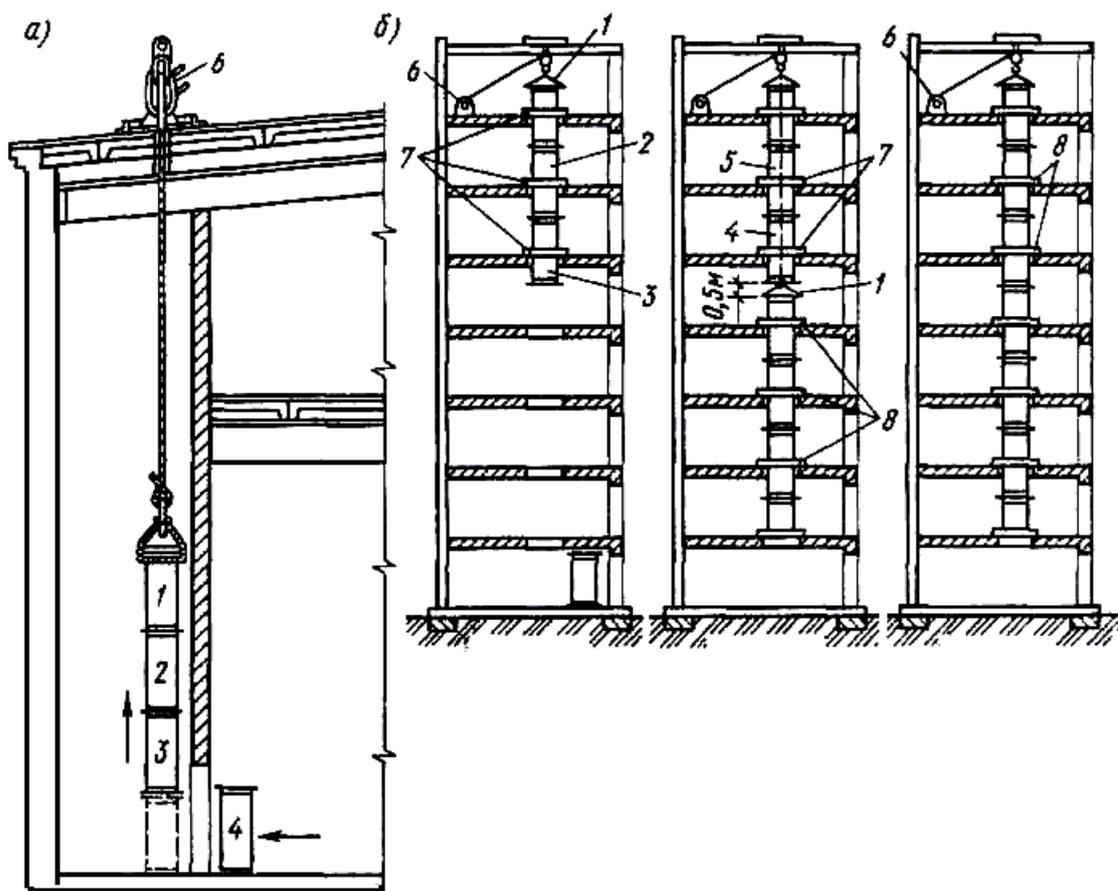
Монтаж вертикальных стальных воздухопроводов методом наращивания:
